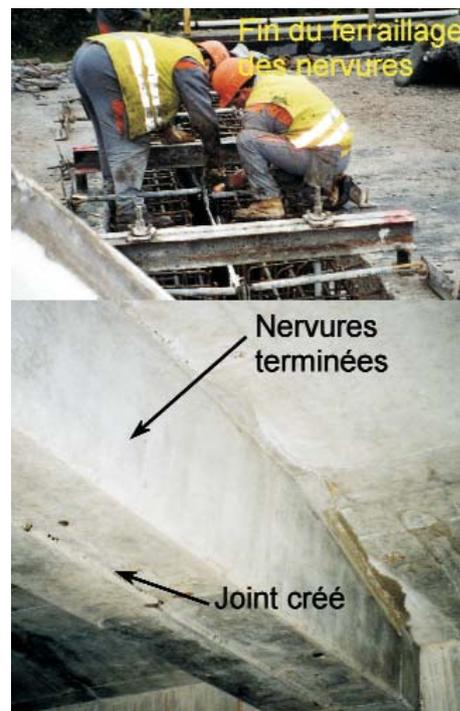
bétonnage des nervures et nervures terminées (photo Poineau)
